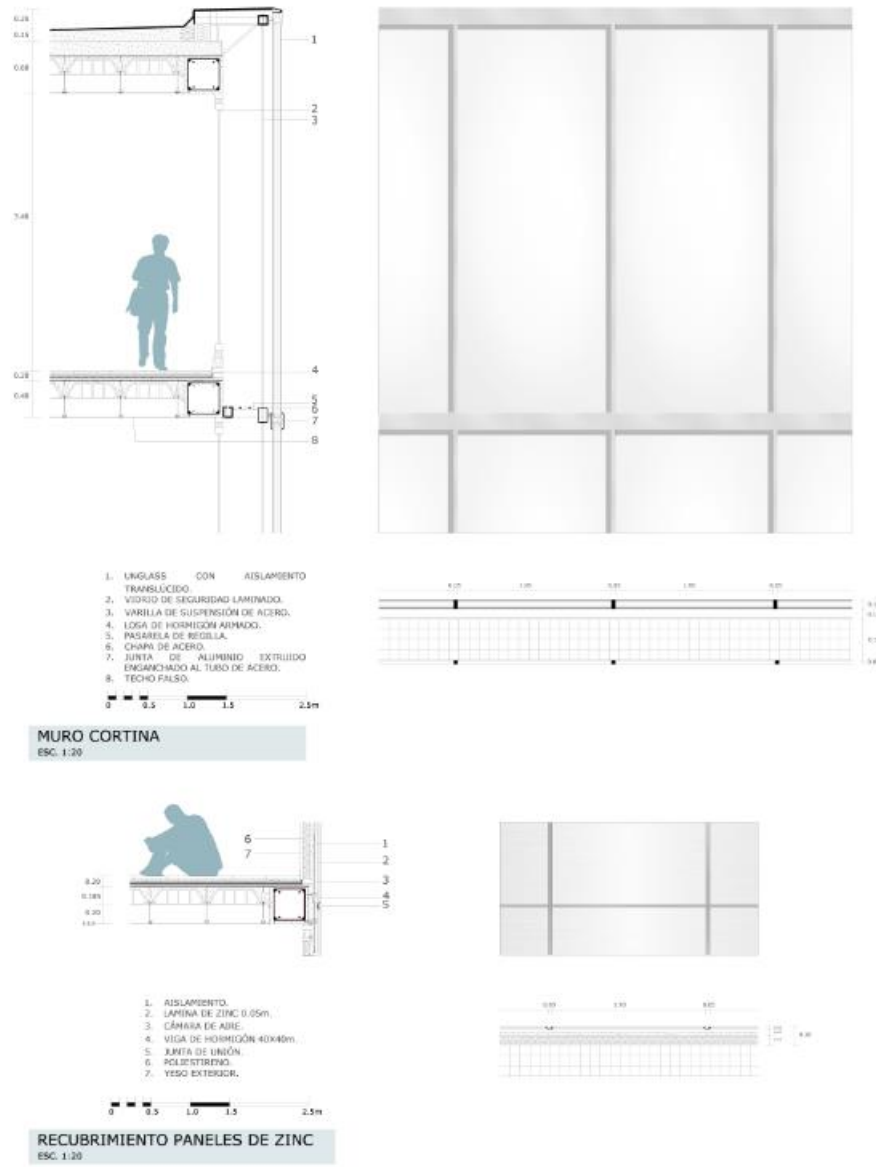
Detalles constructivos 2 y 3. Elaboracion propia.
